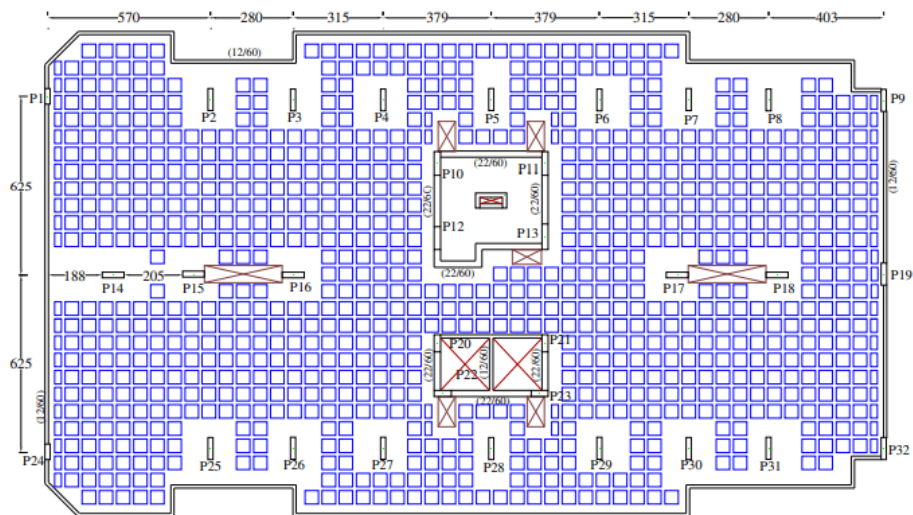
Planta baixa do pavimento tipo da segunda estrutura analisada (DUMARESQ, 2008) – cotas em cm
